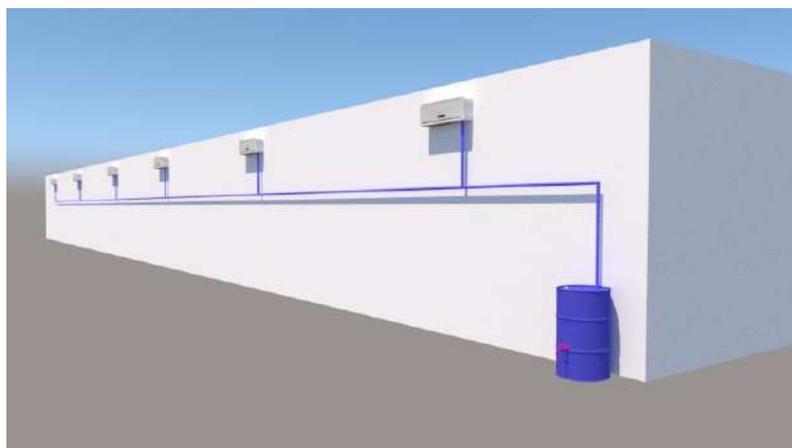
Projeto de captação de água dos aparelhos de ar-condicionado do pavilhão inferior da Faculdade de Iporá, FAI.
